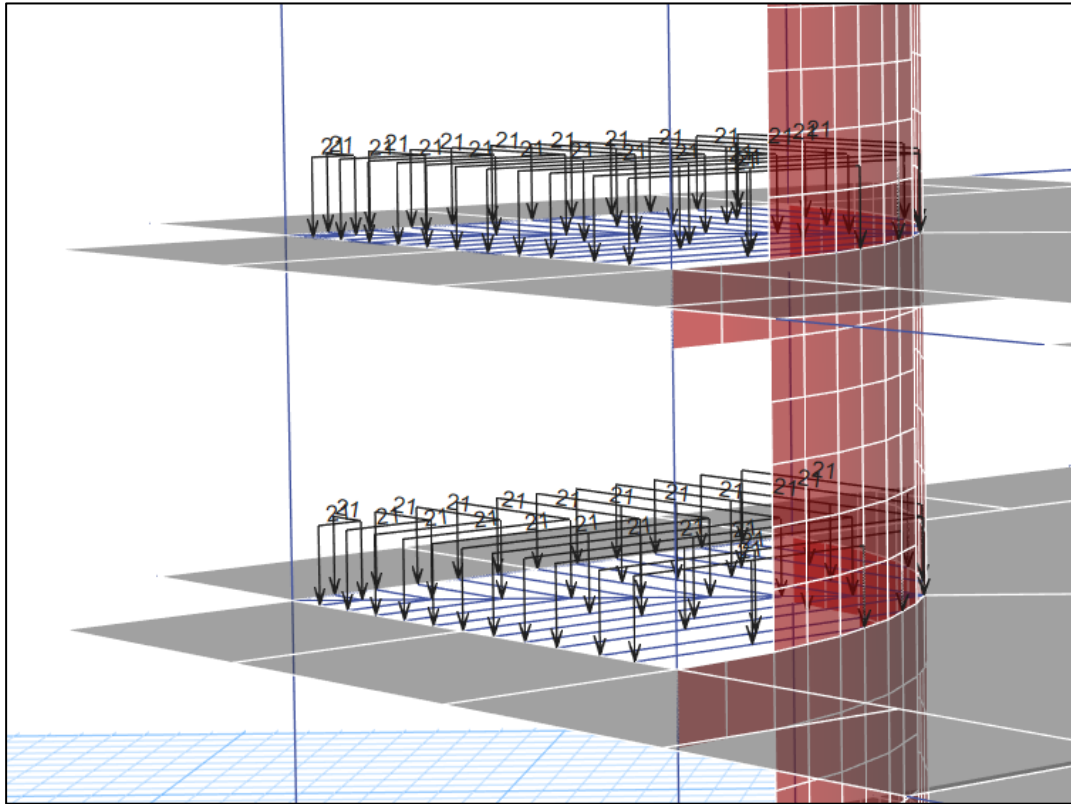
Cargas No estructurales - Oficinas (kg/m)
